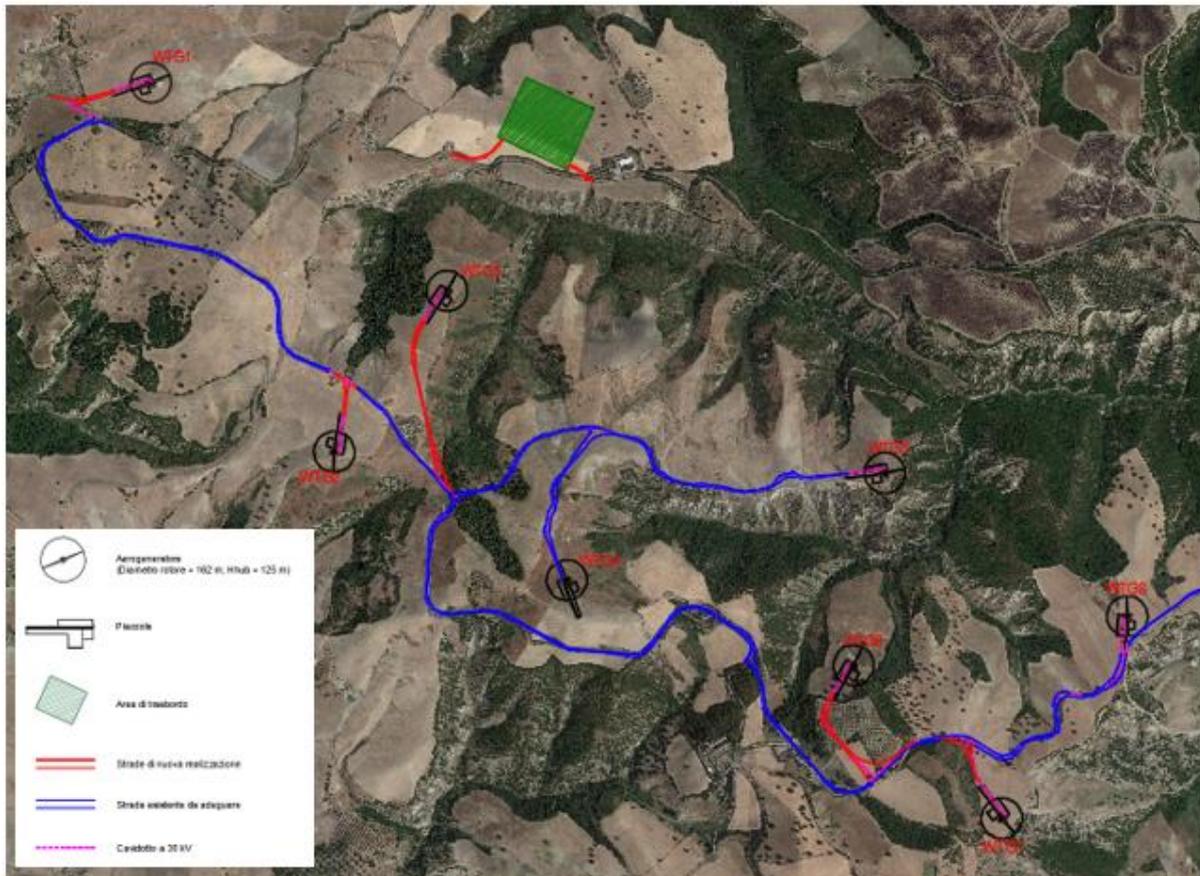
Inquadramento su base ortofoto del layout di progetto (Fonte: Google Earth)
